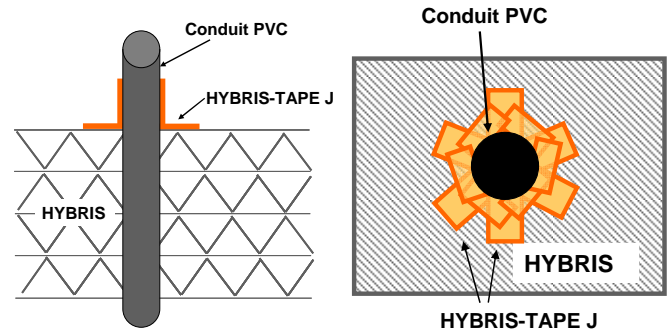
Passage conduit PVC étanché avec HYBRIS-TAPE J
